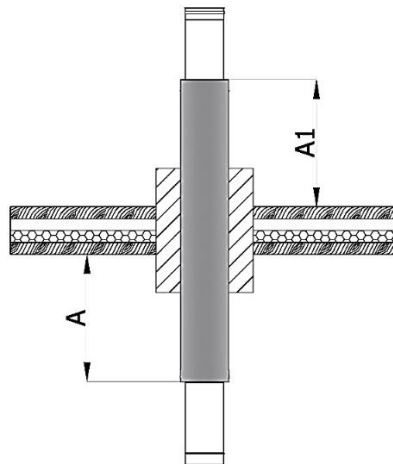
Attraversamento solaio non ventilato con passaggio a tetto
